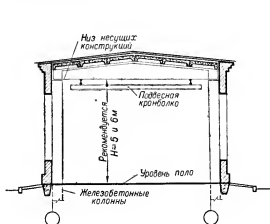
7. Высота зданий с подвесными кранами или без кранов при внутреннем отводе воды.
